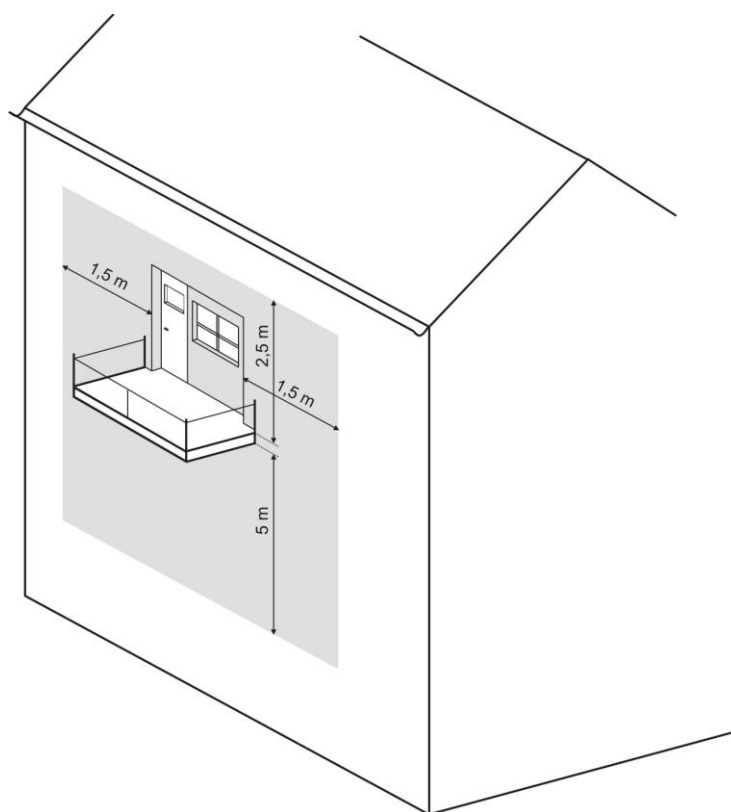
Débouché du terminal sur la paroi, sous un balcon ou une galerie
